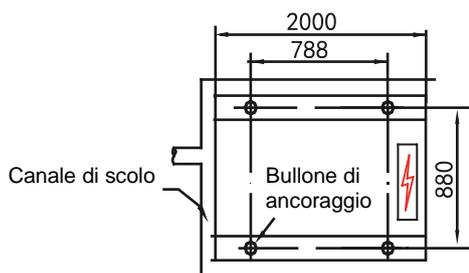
Disegno con dimensioni di installazione di SCV-300EA
